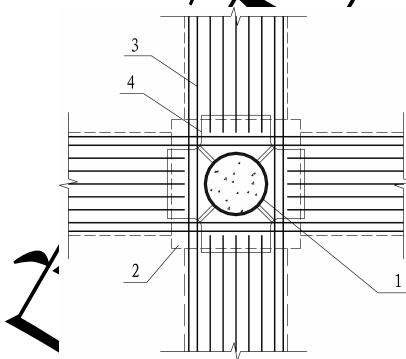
钢筋混凝土梁纵向钢筋与钢管柱传力钢板连接
